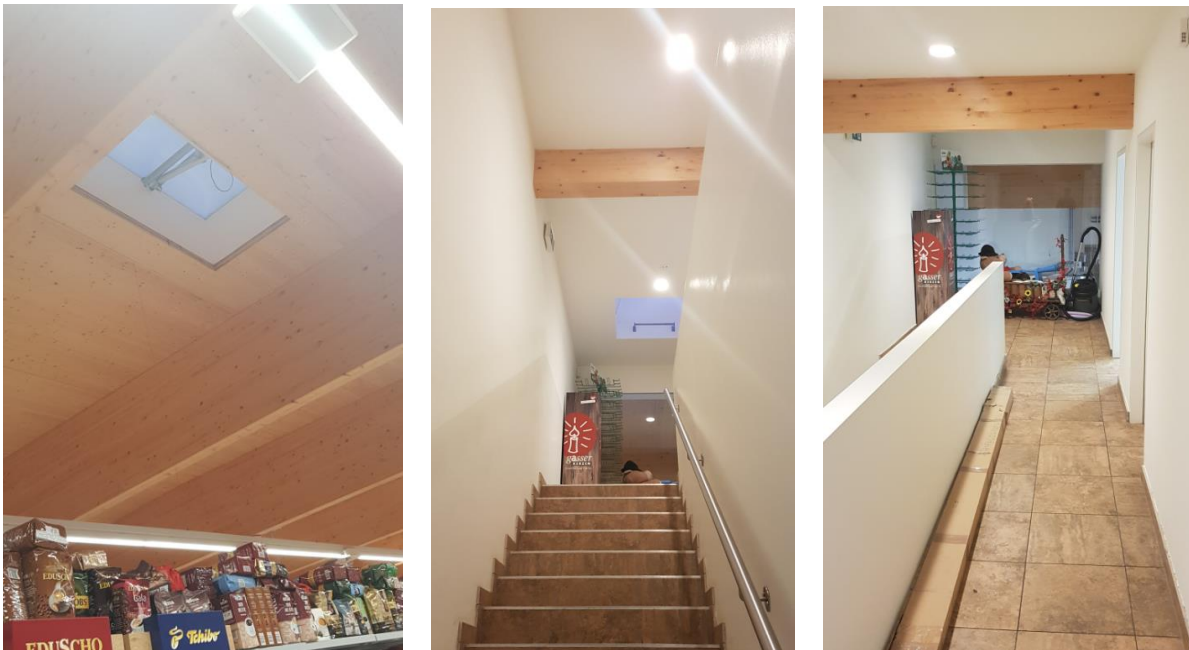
Links: Flachdach Bauweise in Holz, Leimbinder 110/20 in der Querrichtung; Mitte: Flachdach aus Stahlbeton; Rechts: OG mit sichtbarem Leimbinder
